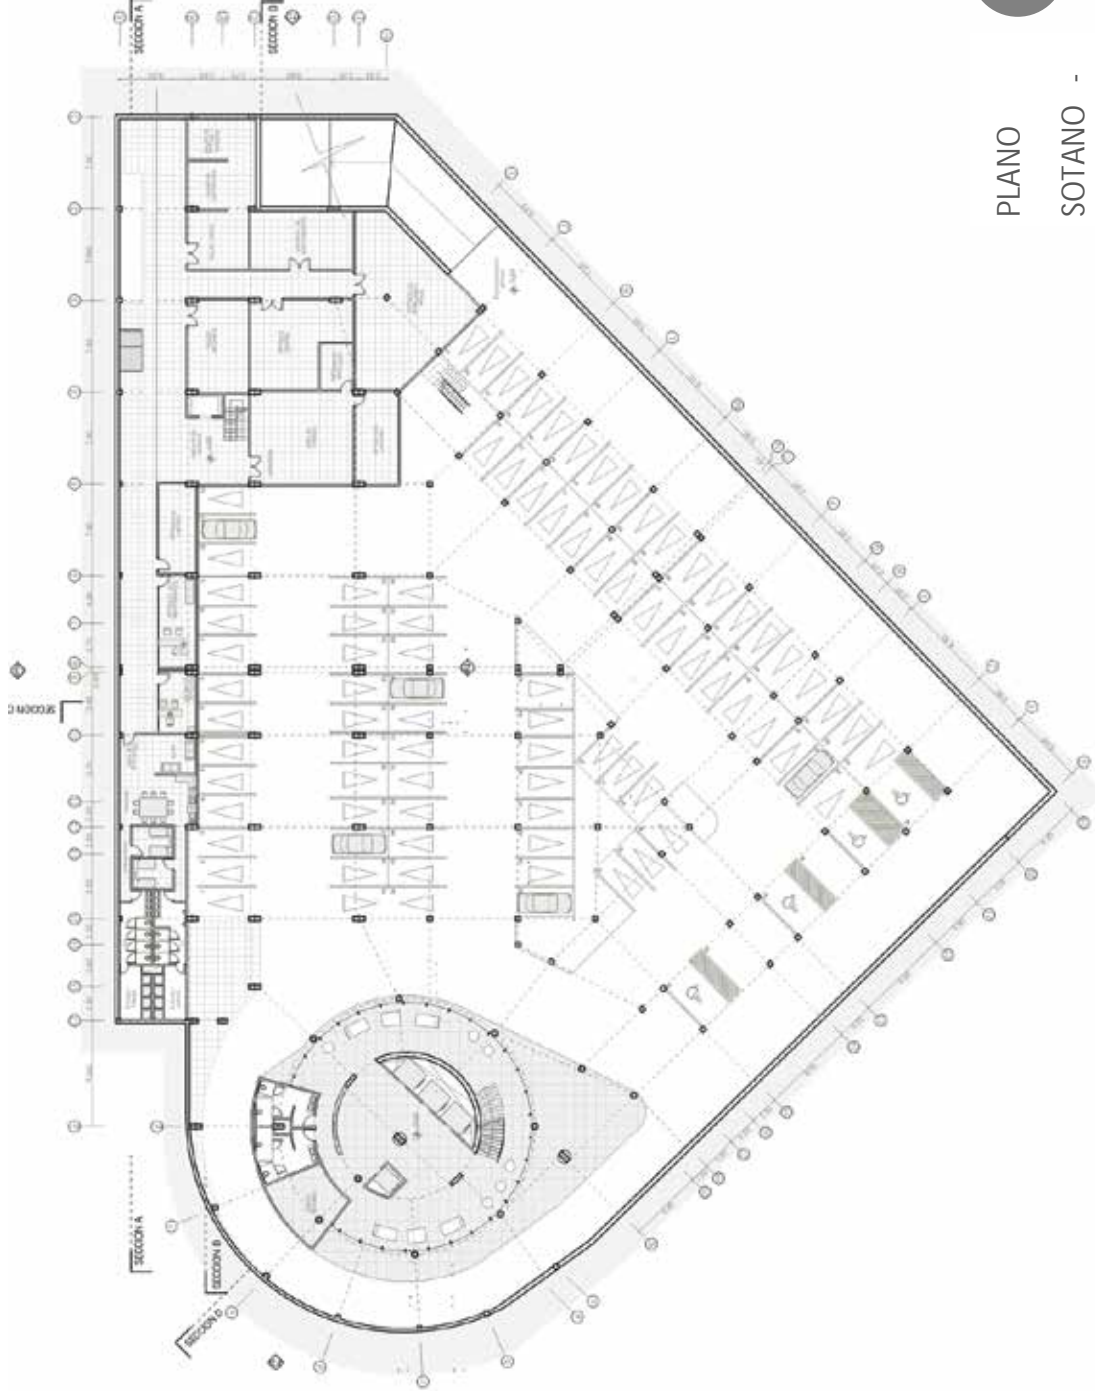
esquema de planta de las áreas del Hotel 3 estrellas (2018)
